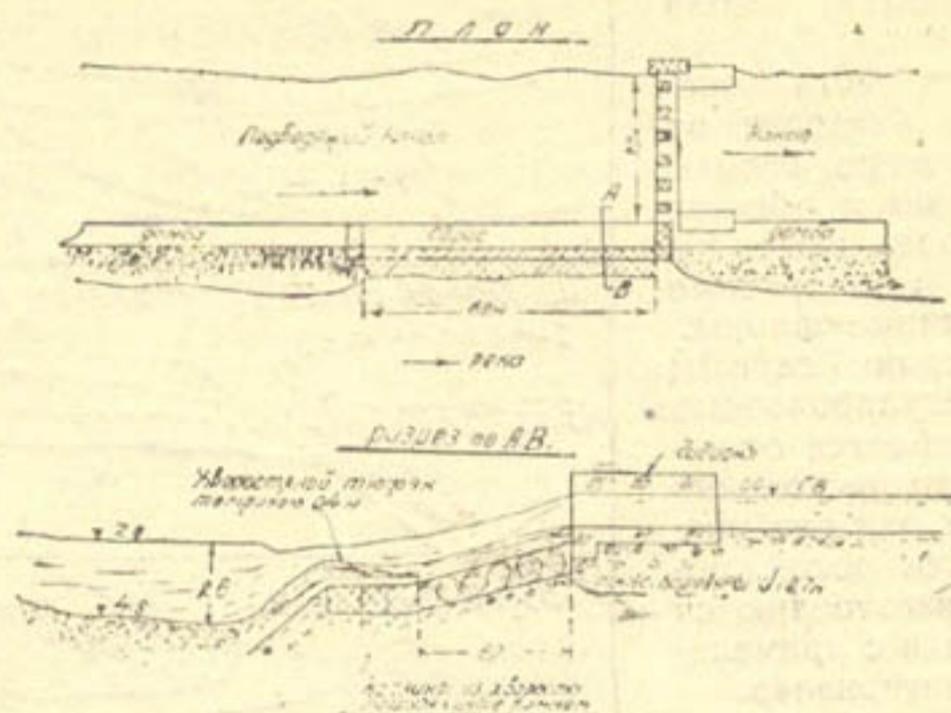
План водозаборного устройства и укрепления нижнего бьефа
